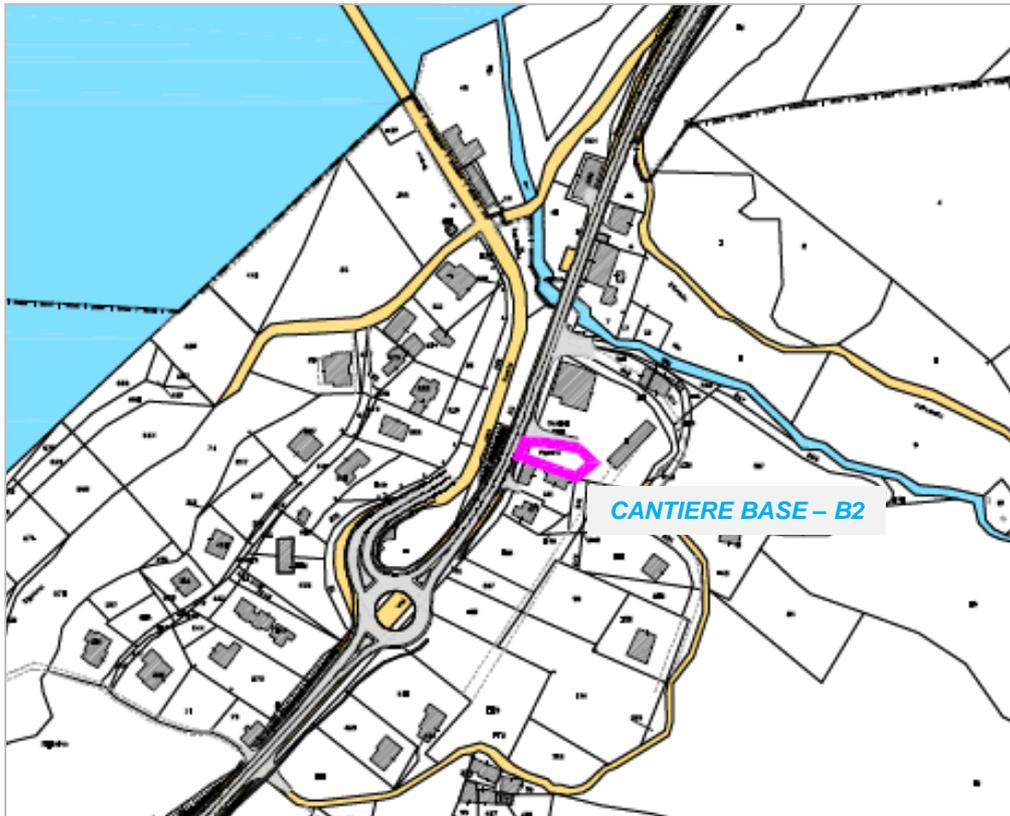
PLANIMETRIA CATASTALE CANTIERE BASE B2
